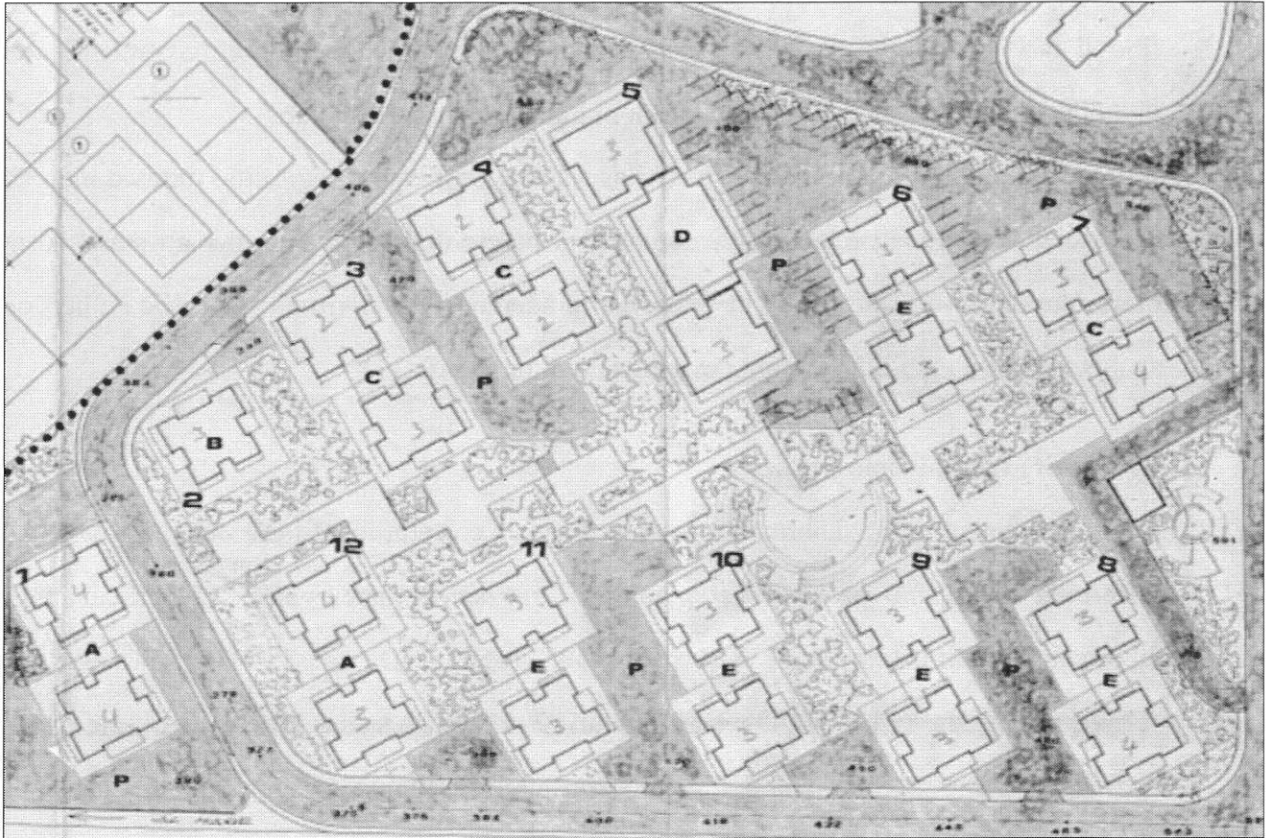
Stralcio planimetria con indicazione dei fabbricati e impianti sportivi.
